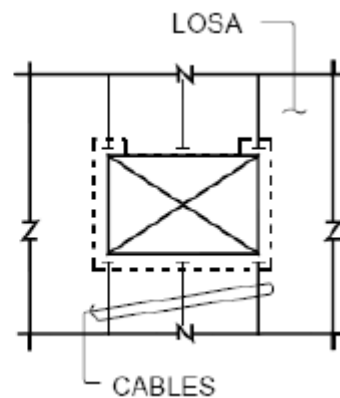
b. Disposición de cables favorecedora de la fisuración. [A2]
